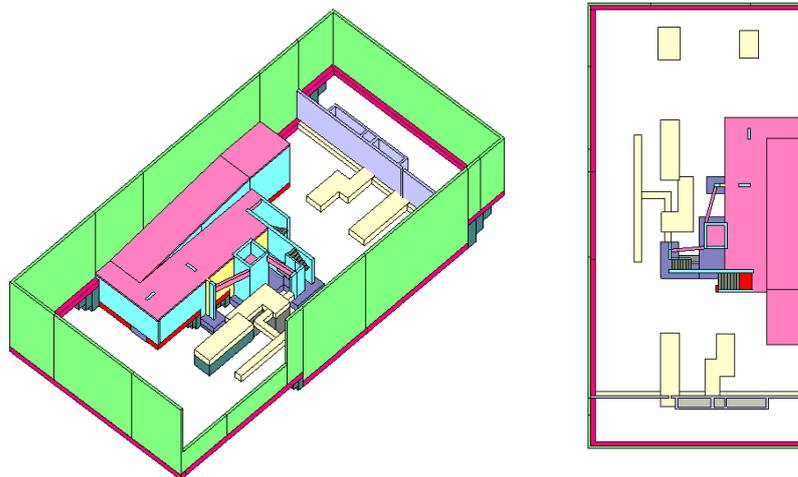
Vista laterales en 3D y en planta del proyecto, usando BIM
